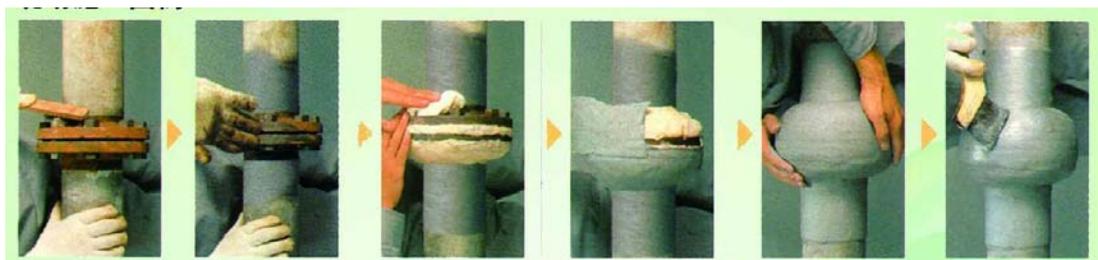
氧化聚合型包覆防腐技术施工示意图（填充胶泥）
